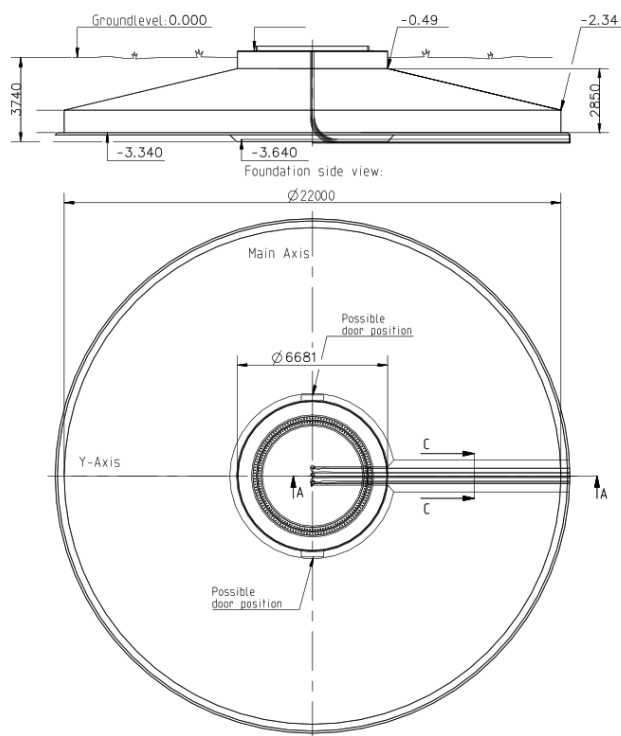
Cimentación propuesta, pendiente de verificar tras estudio geotécnico
